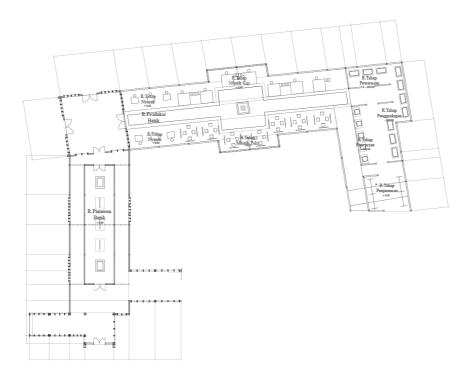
Denah Ruang Informasi dan Ruang Pengelola Sumber: Penulis,2018
